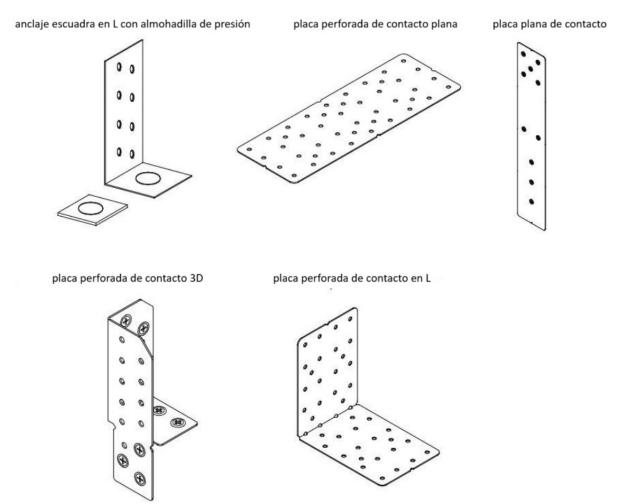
Detalle de la gama de herrajes de brida de Framecad
